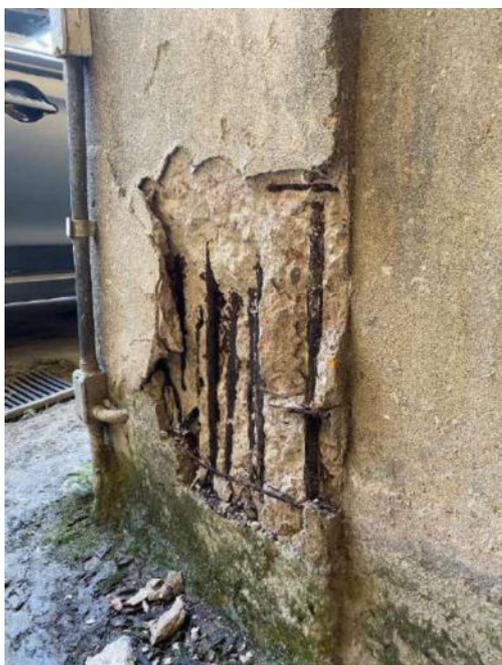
Deslocamento do concreto de cobertura do pilar 32, exposição e corrosão de armaduras
